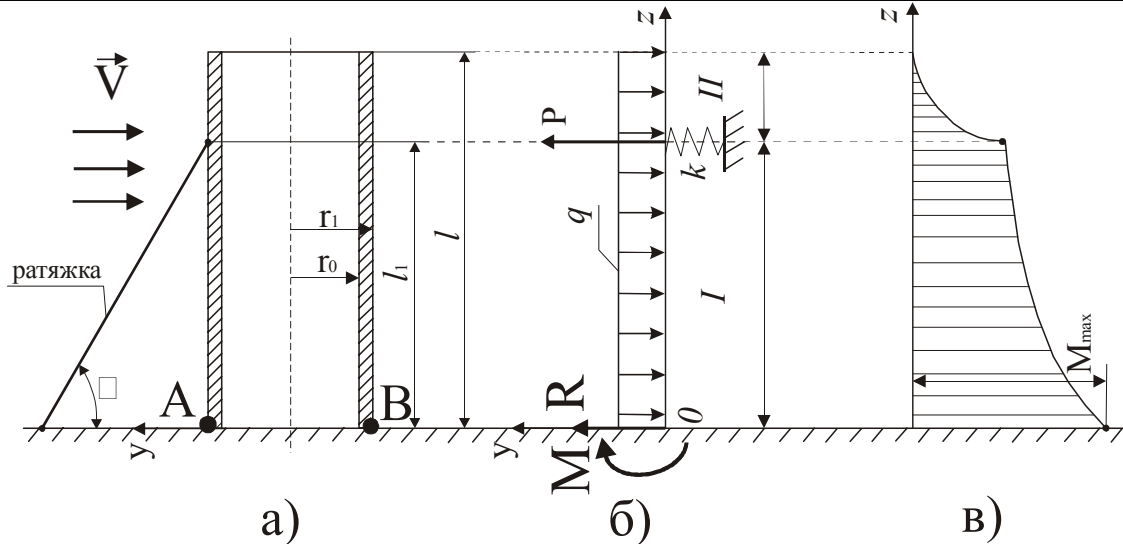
Схема трубы отопительной системы и ее расчетная модель при воздействии ветровой нагрузки
